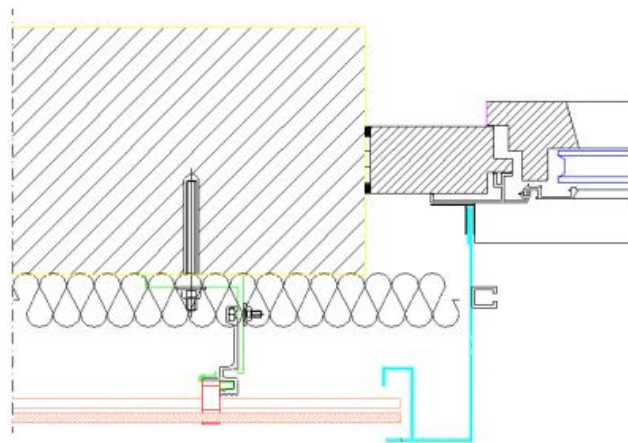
Aplicação da fachada ventilada – Remate da janela com sistema sobreposto [48]
